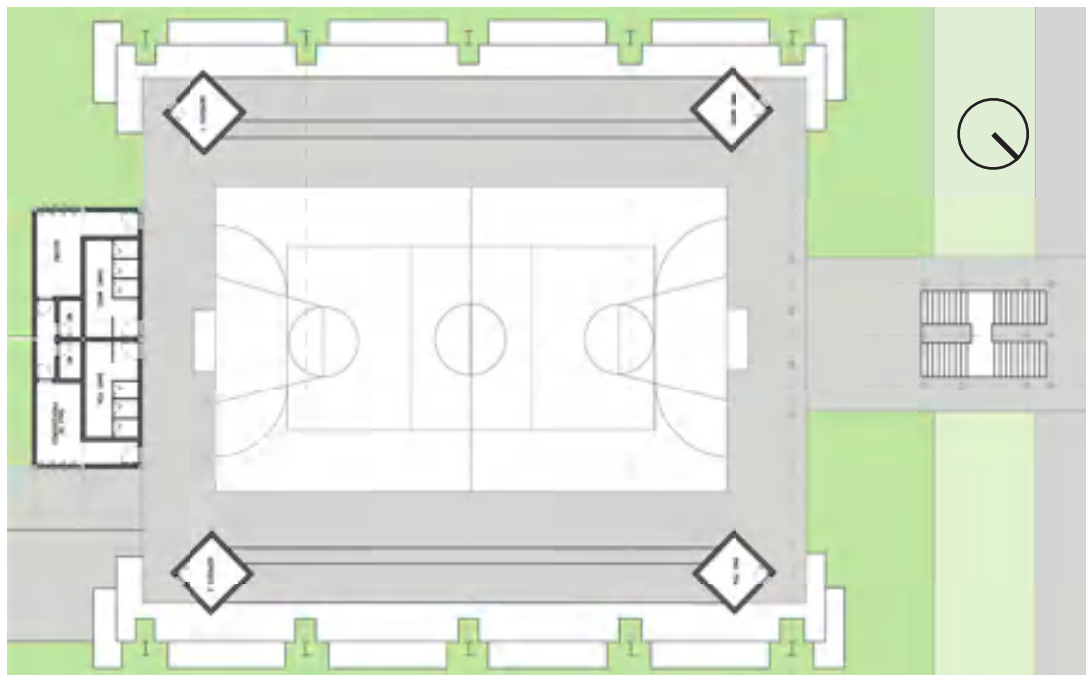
Planta baixa Ginásio CAIC José Jofilly.
